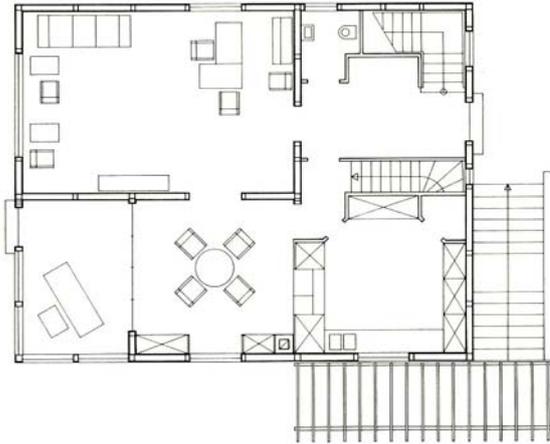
Hans Poelzig, Einfamilienhaus, Weißenhofsiedlung, Grundriss Erdgeschoß
